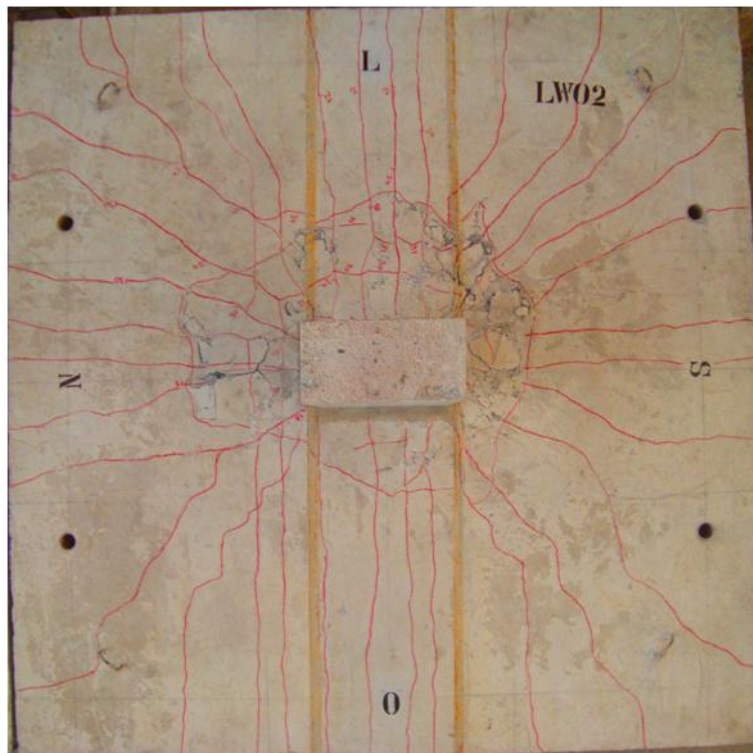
Padrão de fissuração do modelo LW02.
